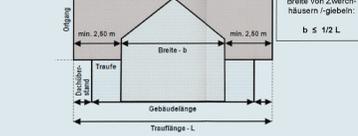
Abmessungen zulässiger Zwerchhaus-/gebel (hier Beispiel: Zwerchhaus)
